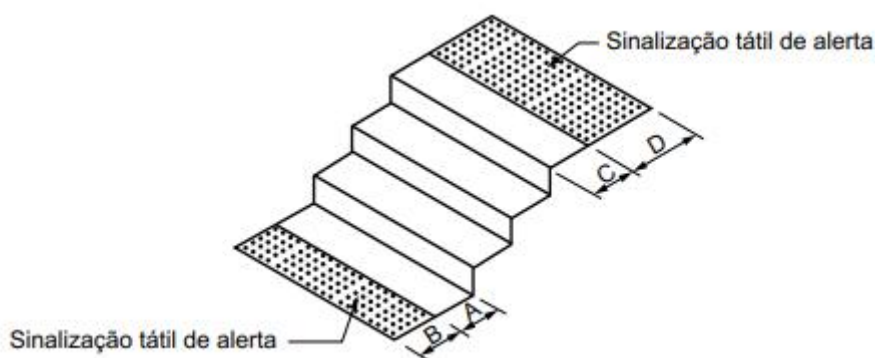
Piso tátil de alerta em escadas (Fonte: NBR 16537)
